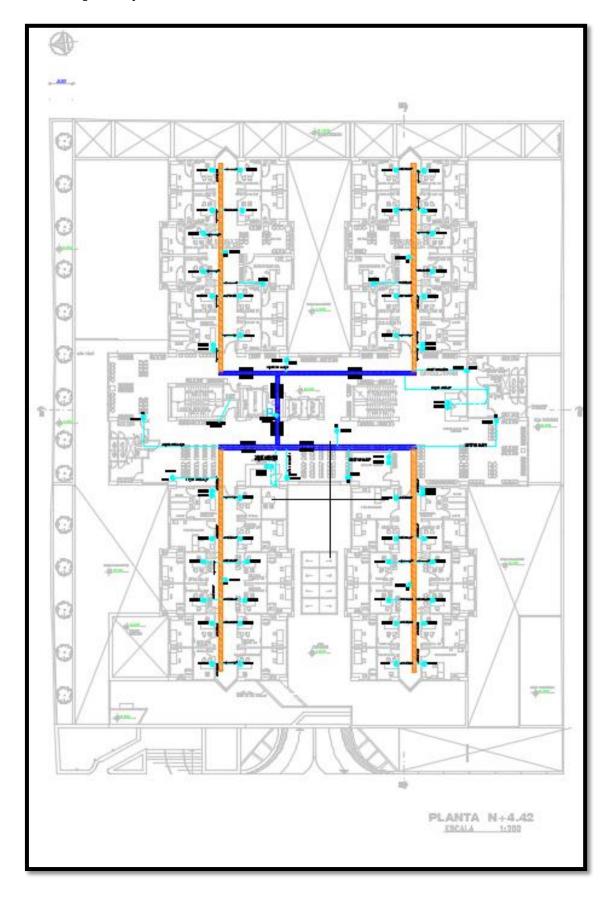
Plano segundo y tercer implementado el cableado estructurado.
